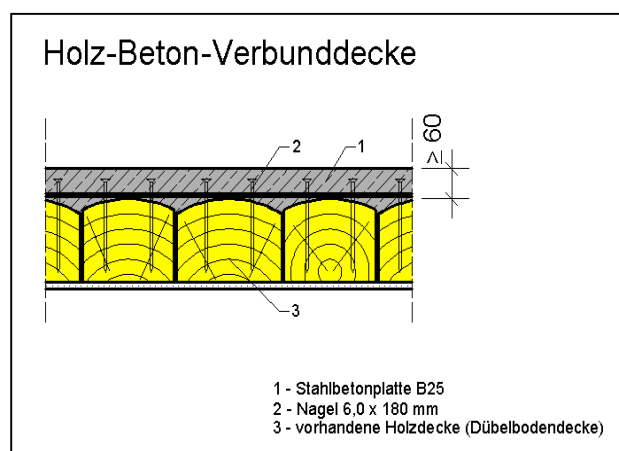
Holzbeton- Verbund mit Nägeln nach [46]
